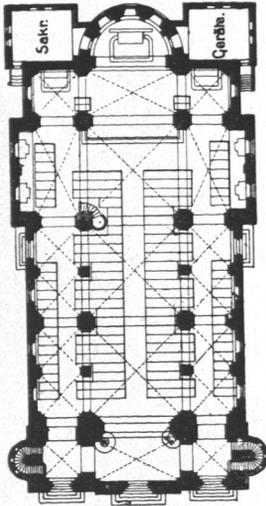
Marien-Kirche in der Danzigerstraße, Grundriß.
